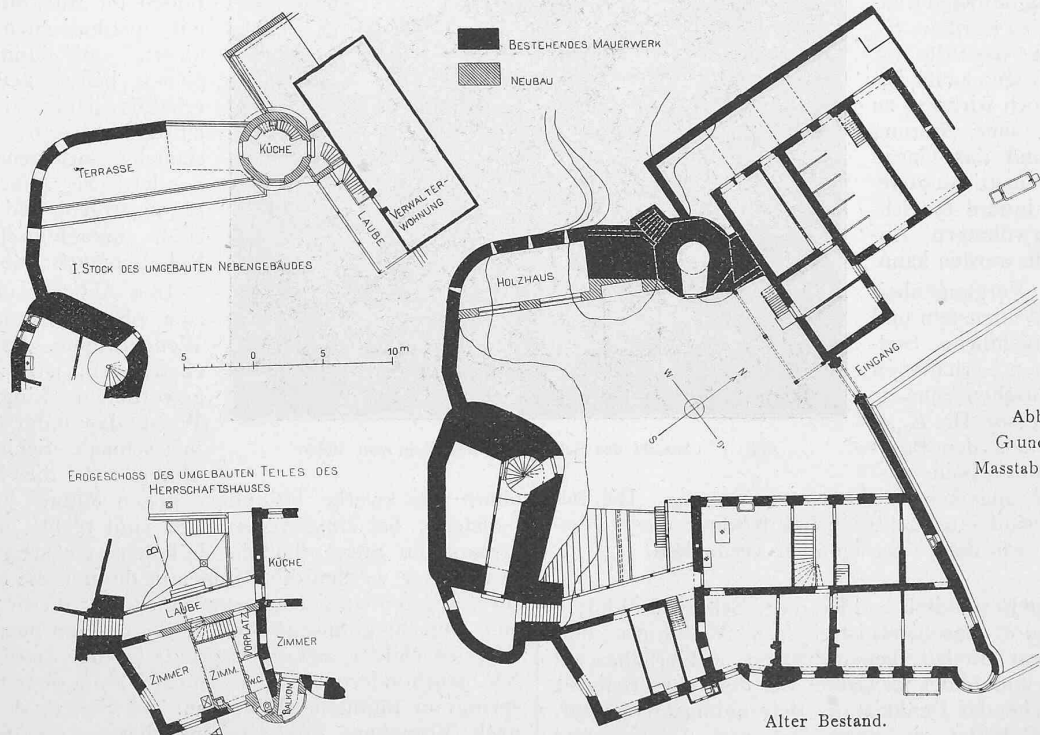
Grundrisse. Masstab 1 : 500.
